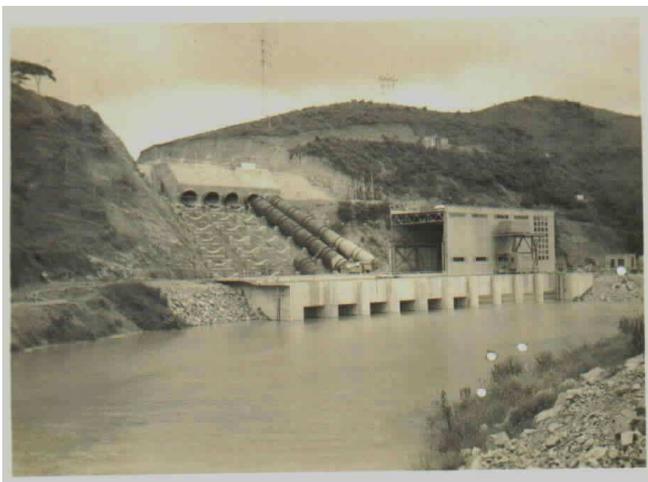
Reversão do rio Pirai: elevatória do Vigário
